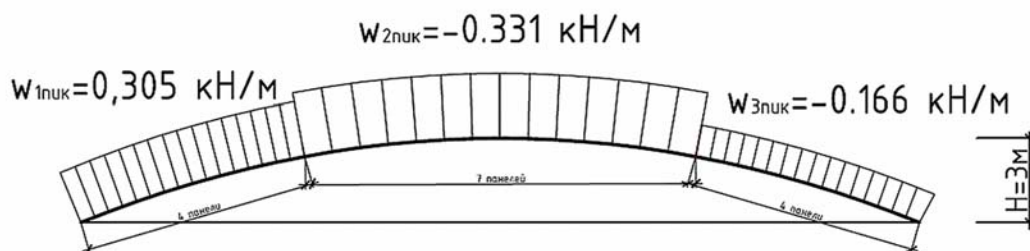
Схемы распределения ветровой нагрузки по пластинам покрытия
